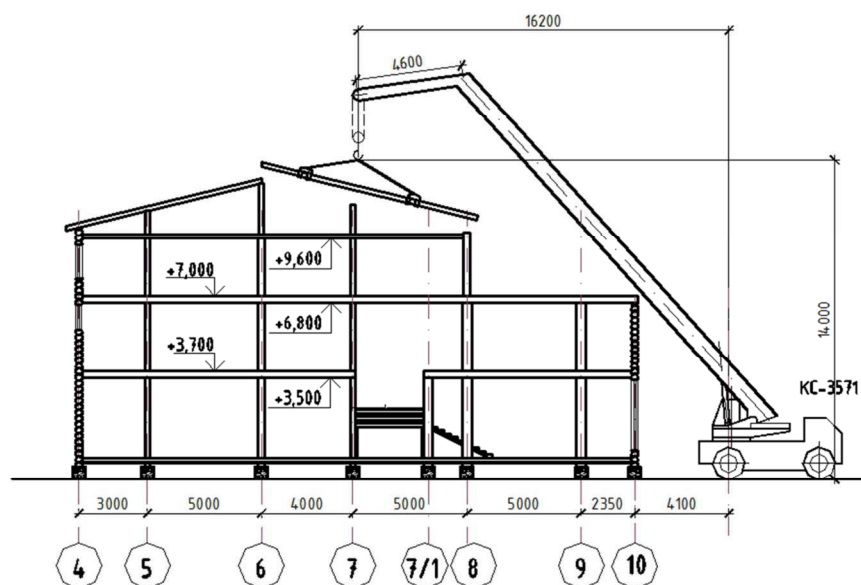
Привязка крана к зданию, при монтаже стропильной ноги
